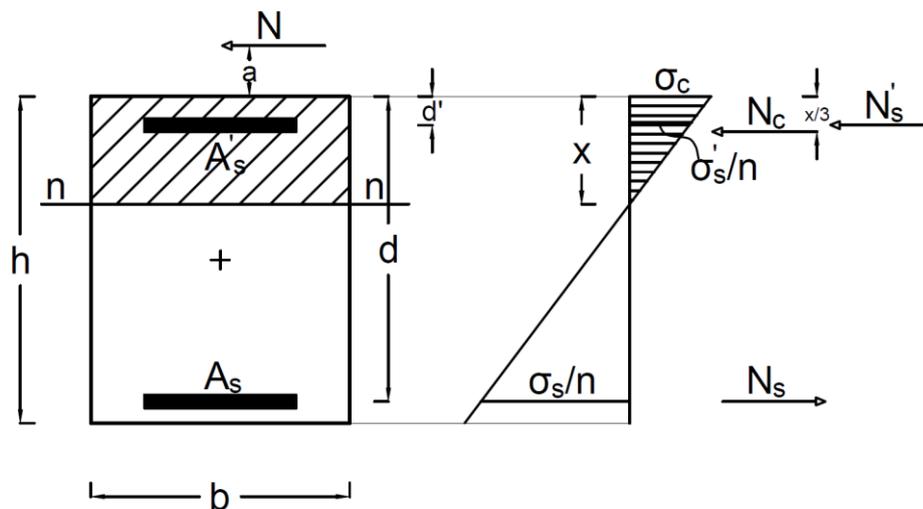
Sezione rettangolare armata soggetta presso-flessione (lo sforzo normale è applicato all'esterno della sezione)
